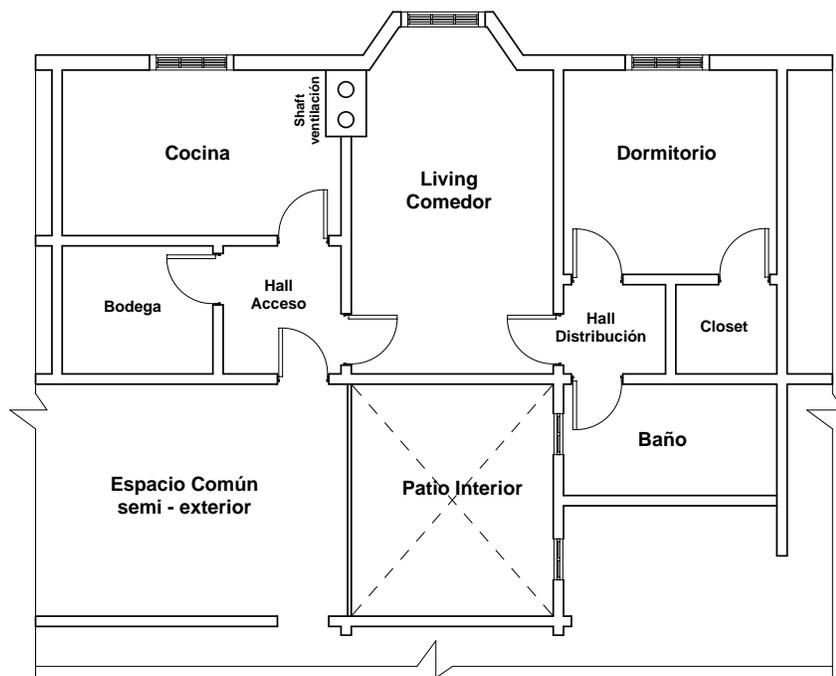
Planta unidad de vivienda (fuente: Elaboración propia en base a planimetría de 1940 aproximadamente, 2019).
